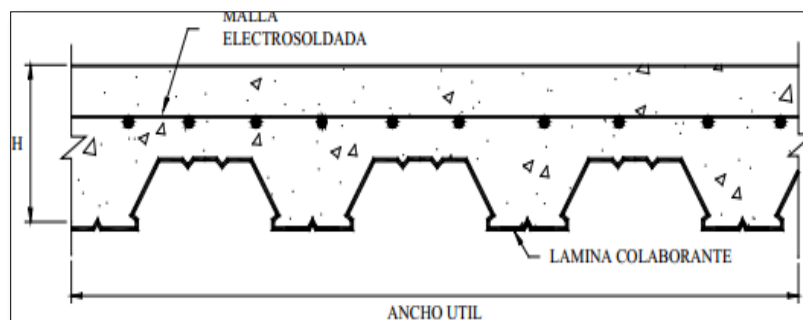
Sección típica del sistema de losa con láminas colaborantes
